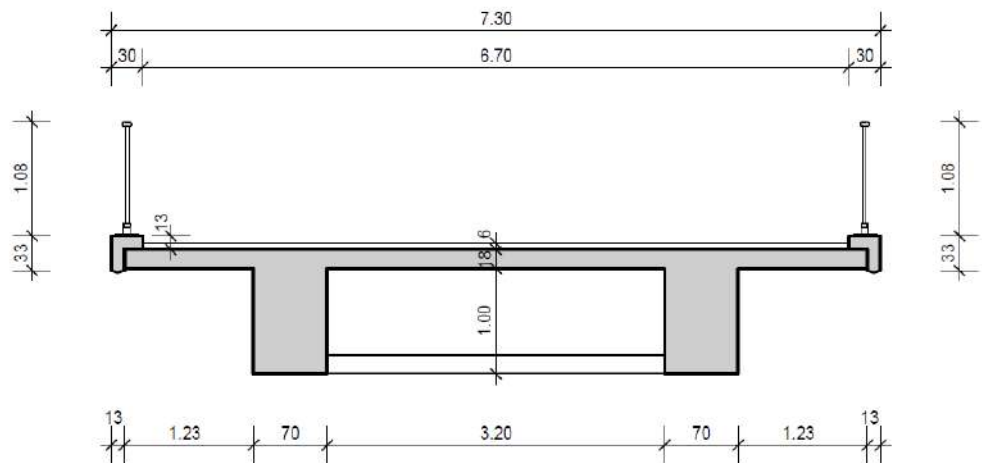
Brückenquerschnitt des Rosemeyer Stegs
